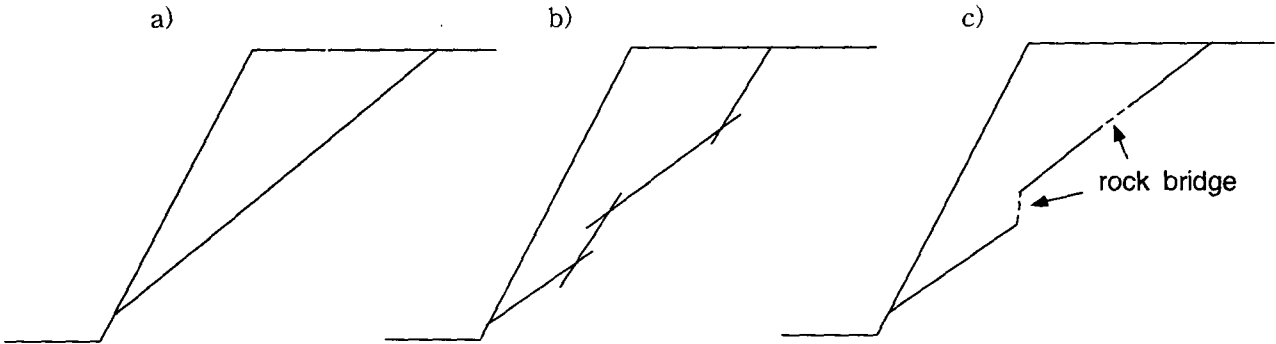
암반 사면의 활동면 형태. a) single joint, b) joint-joint, c) joint-rock bridge system
